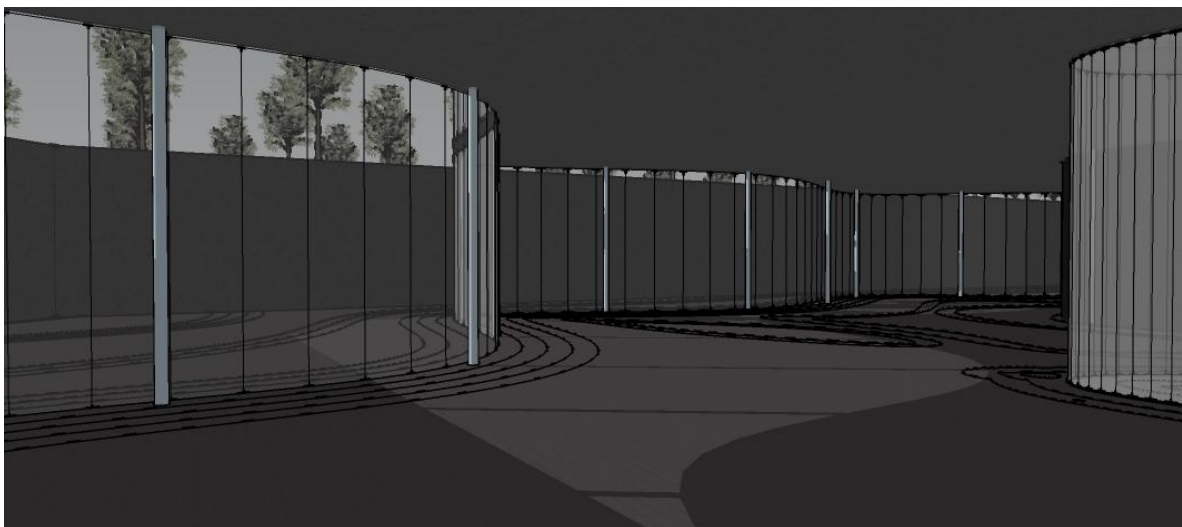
Espacio interno planta baja. Propuesta alterna al MUAC Por CMG.
